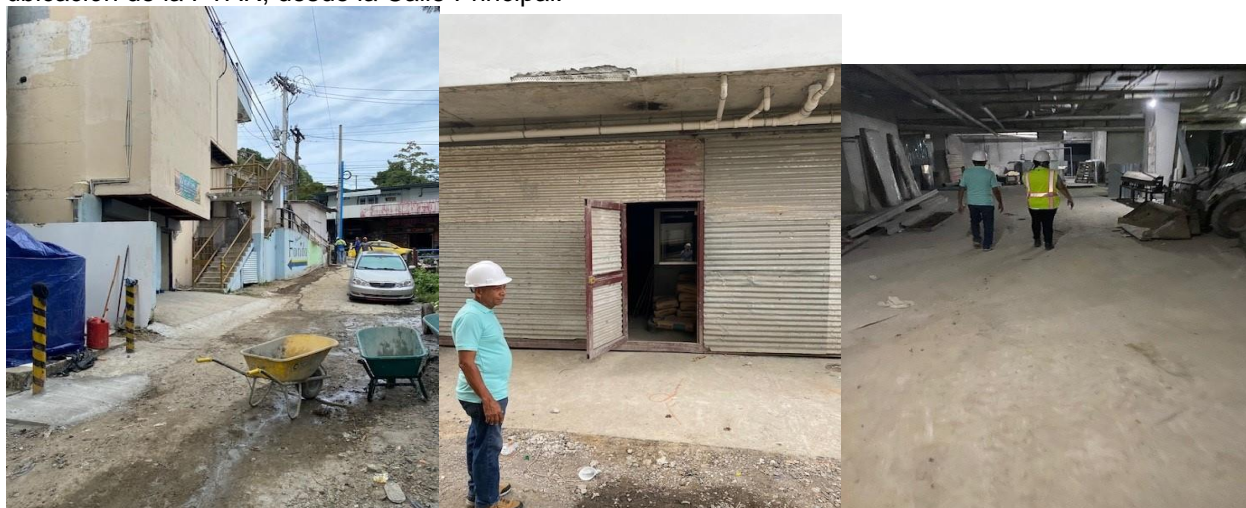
Vereda de acceso. Foto.4.5. Puerta de acceso al edificio desde la vereda. Foto.4.6. Recorrido interior del edificio para acceder al sitio de la PTAR.
